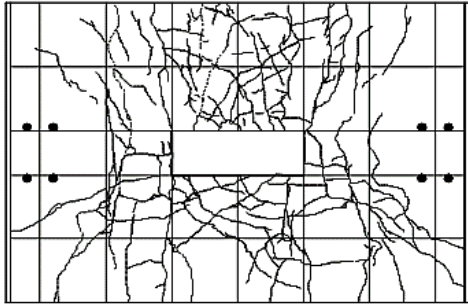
実験最終ひび割れ (スラブ上面)³⁾
